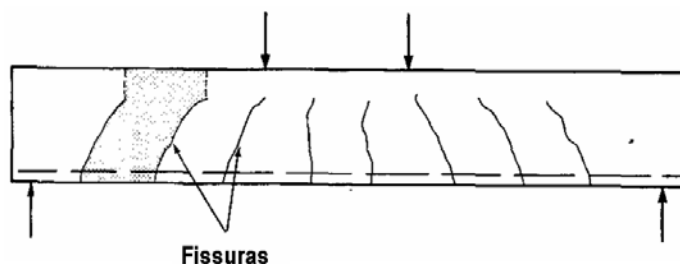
Vista lateral de uma viga fissurada – FONTE: MacGregor, 2005
